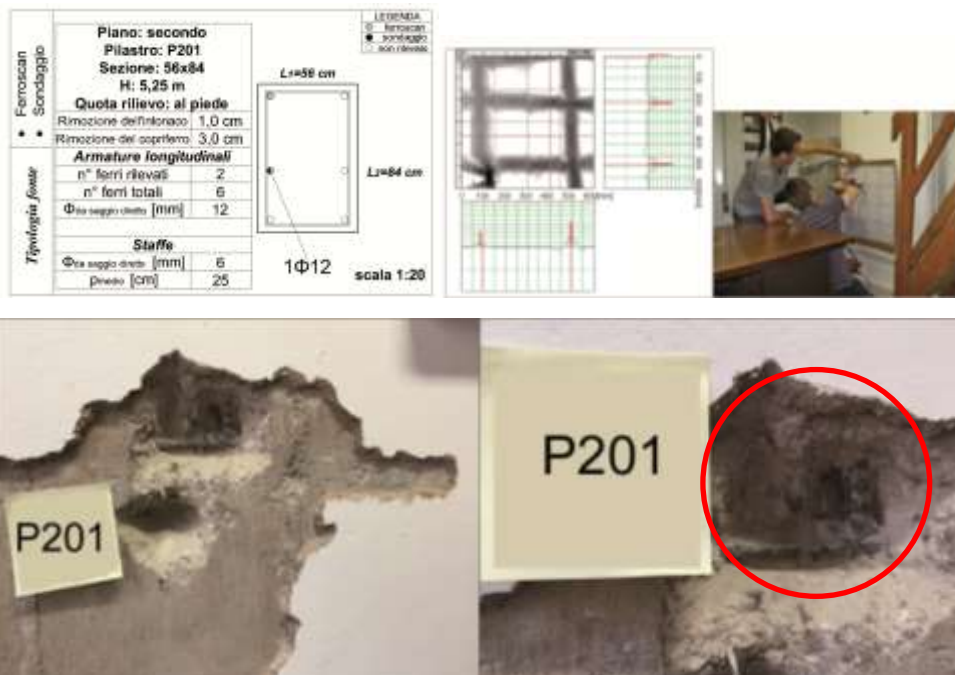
Rilievo pacometrico e saggio diretto sul pilastro in corrispondenza del giunto al piano secondo.
